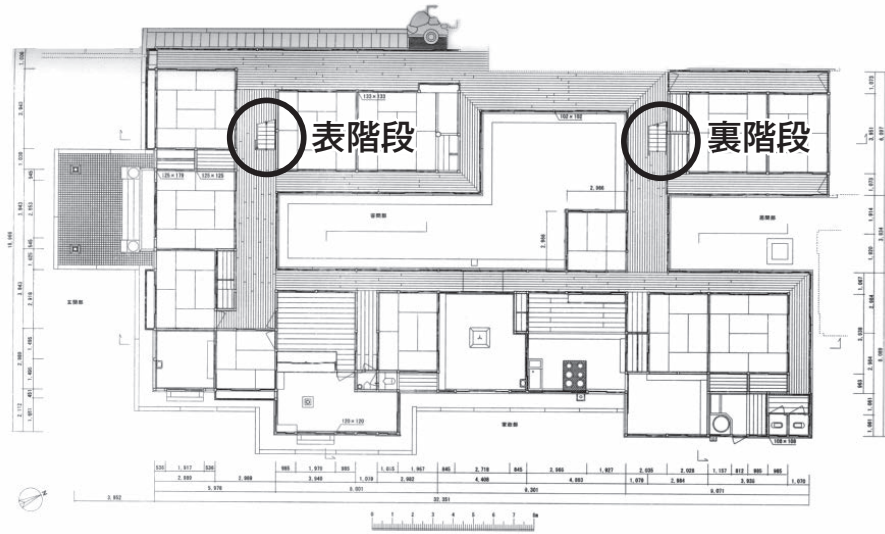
旧鍋島家住宅 1階平面図 文化庁文化財部『月刊文化財(614号):24-26』(第一法規株式会社 2014)
